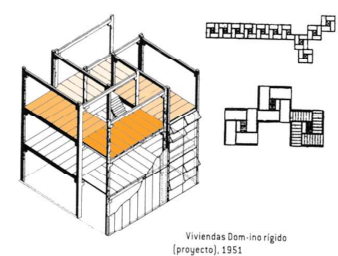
Domino rígido (Proyecto) Plantas e Isometría 1951. James Stirling.
